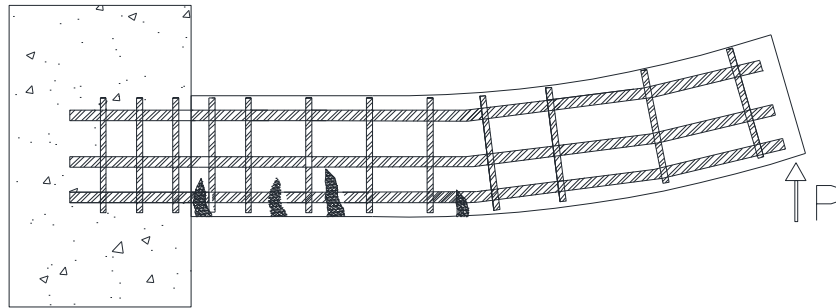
Grietas por la carga hacia arriba (Adaptada de Gallego, Sarria 2010)
